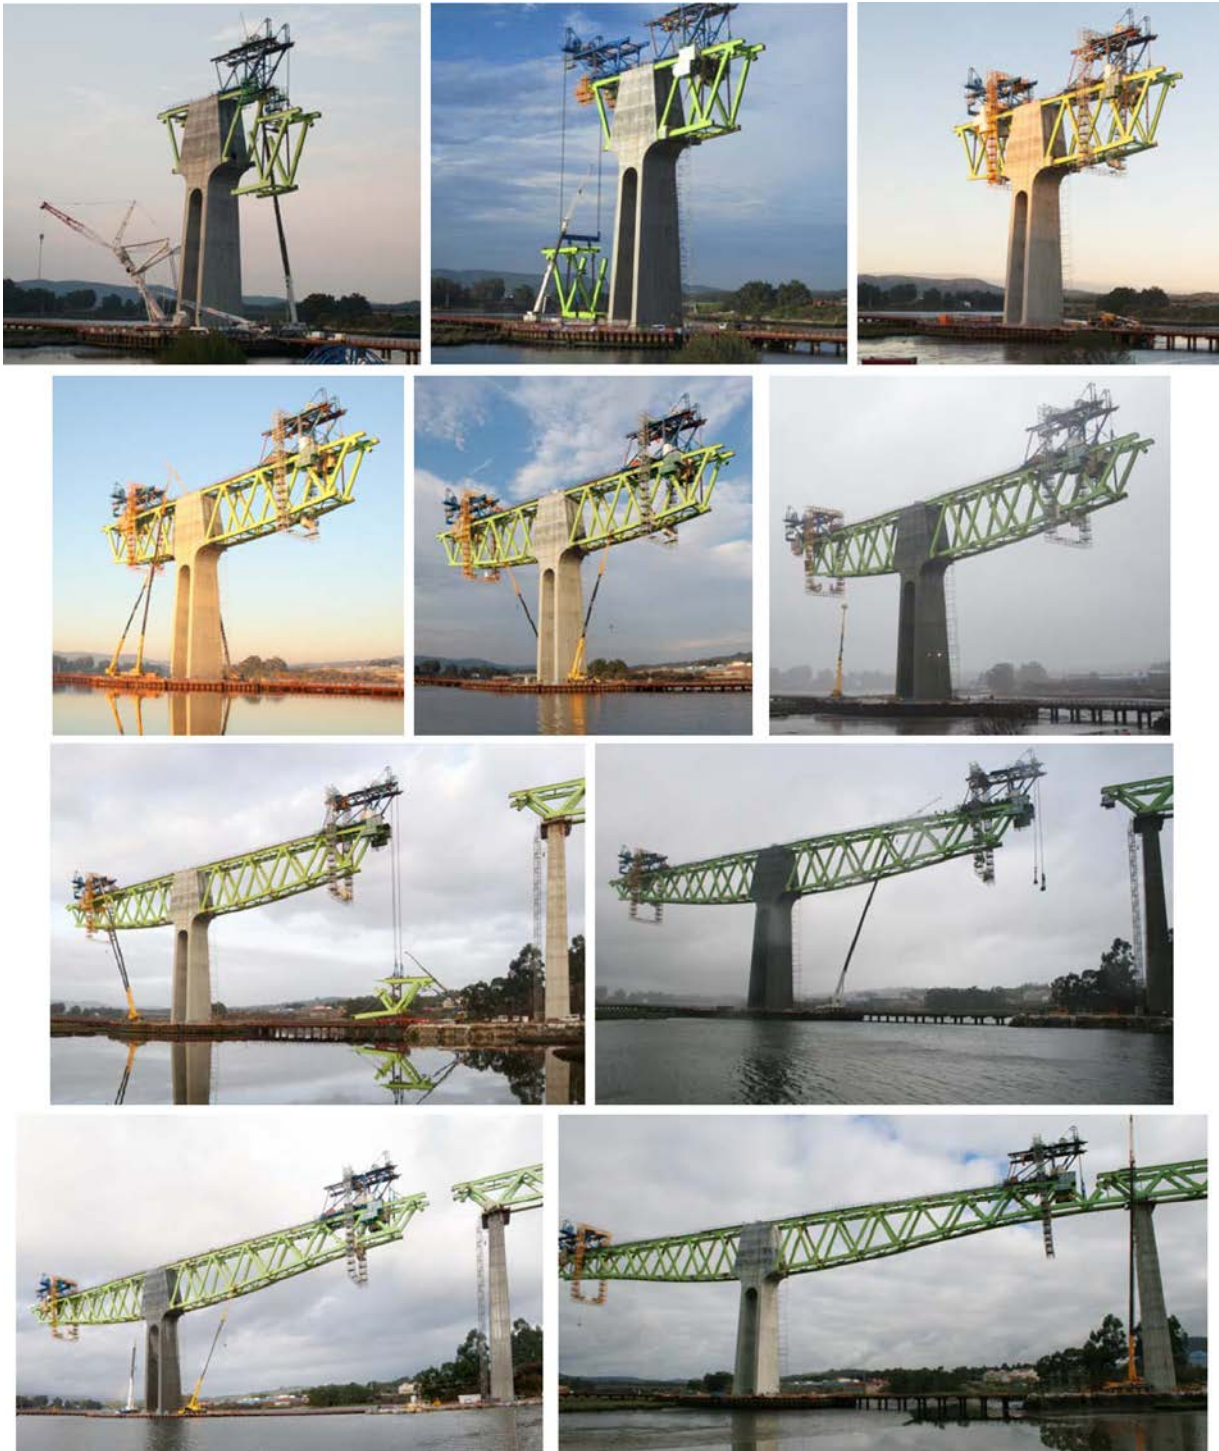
Diferentes vistas del avance por voladizos sucesivos compensados. Pila 5 en primer plano.
